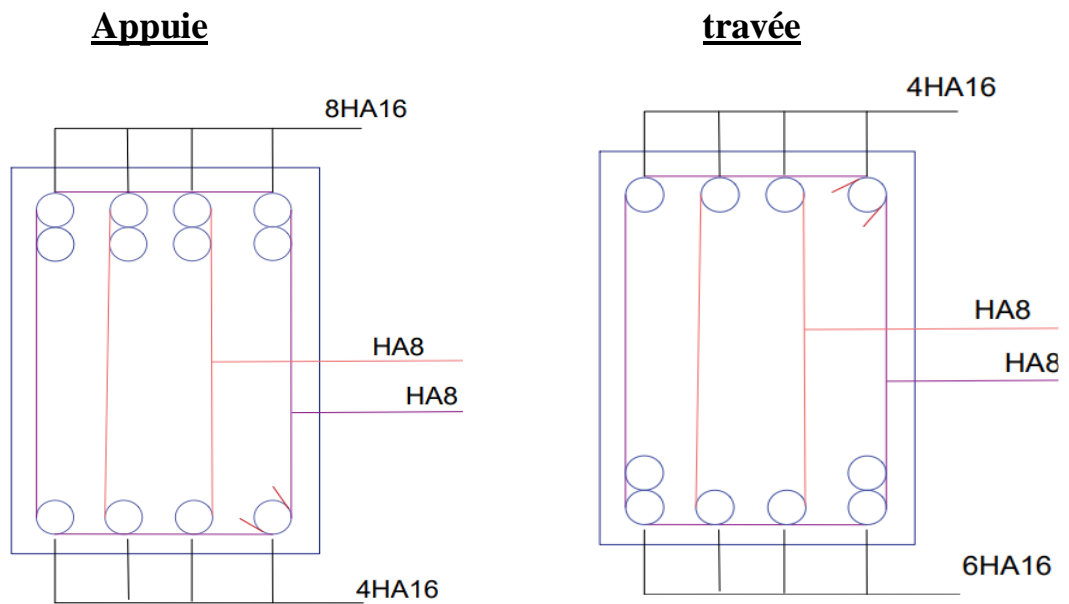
Schéma de ferrailage de poutre principale 30x60.
